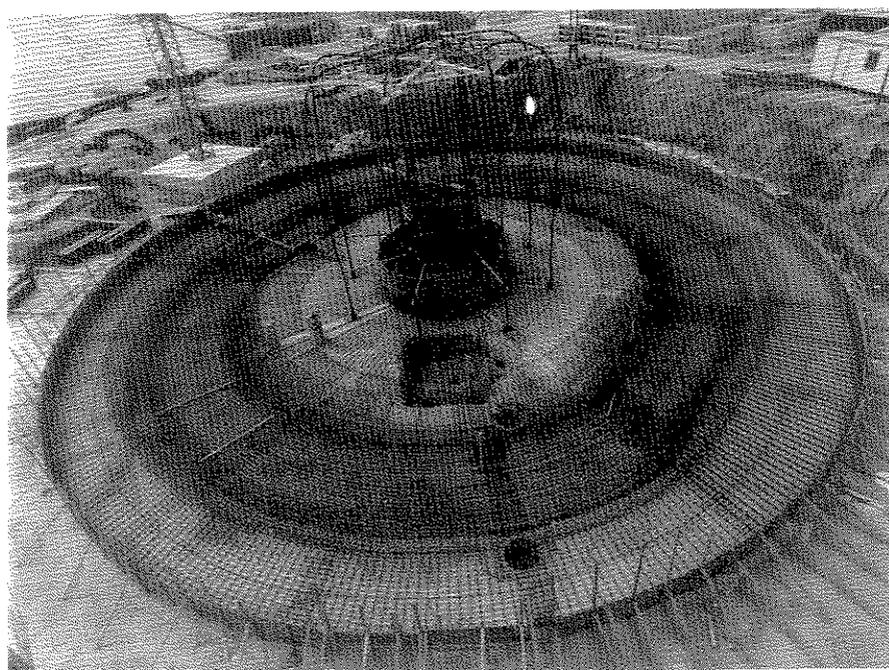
Vista aérea de la losa de cimentación y el pretensado de los pilares interiores.
